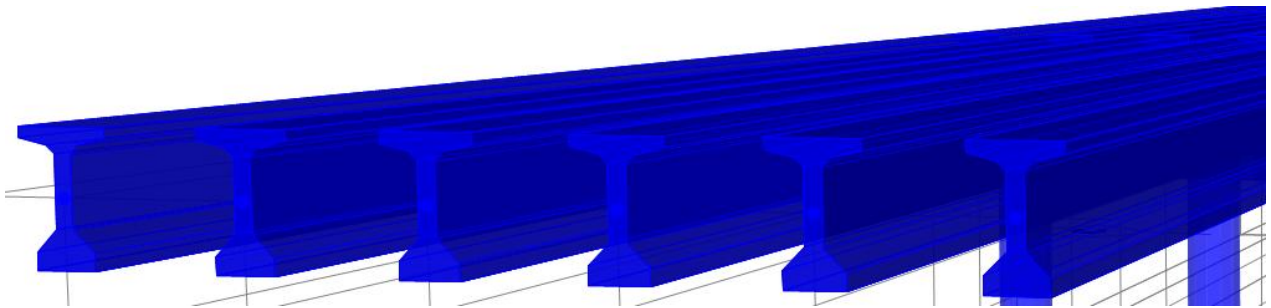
Modelo de 6 vigas AASHTO IV de concreto presforzado
